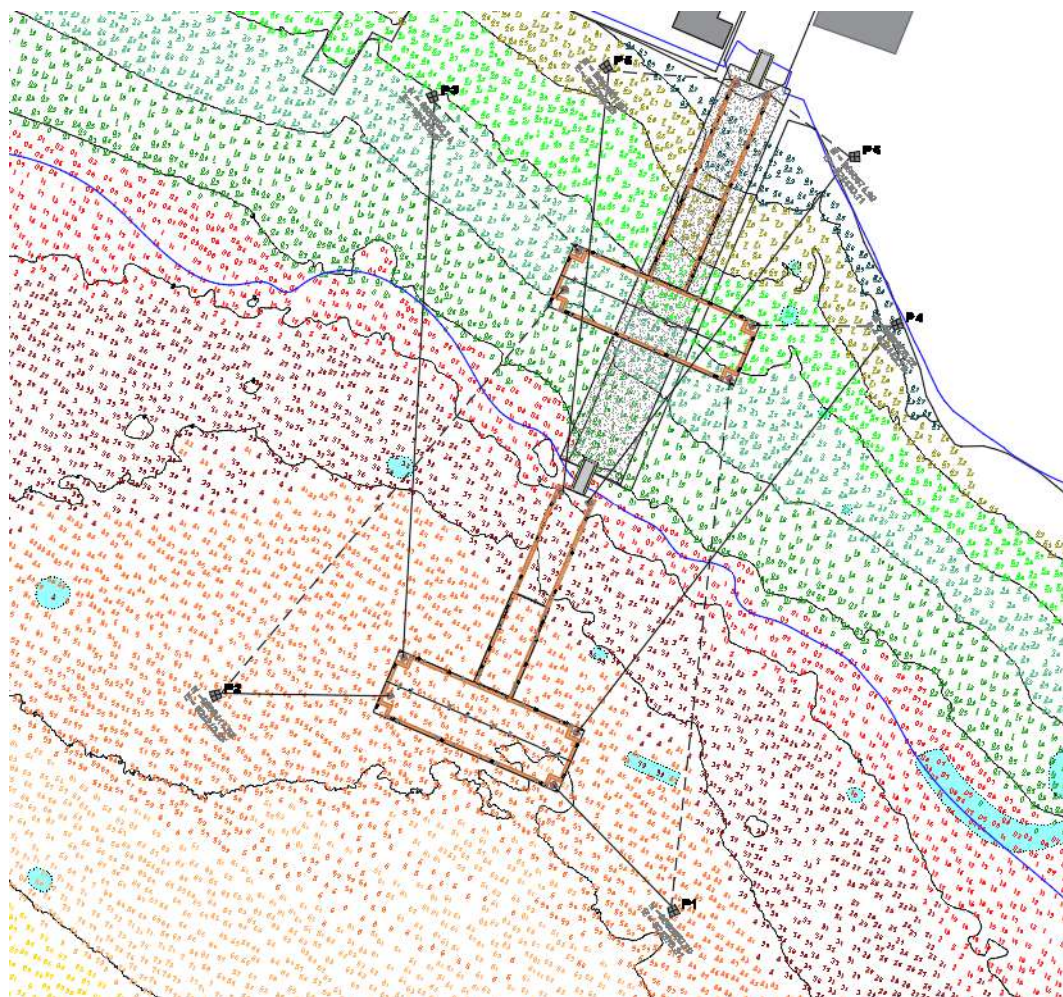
Layout Futuro de amarração e fundeio - Porto CECMA.
